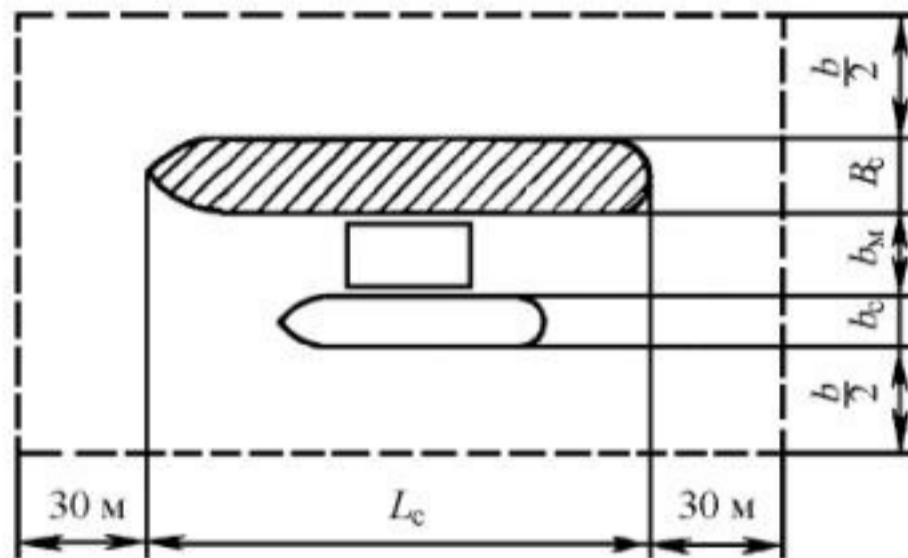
Расчетная схема для определения площади оперативного рейда
